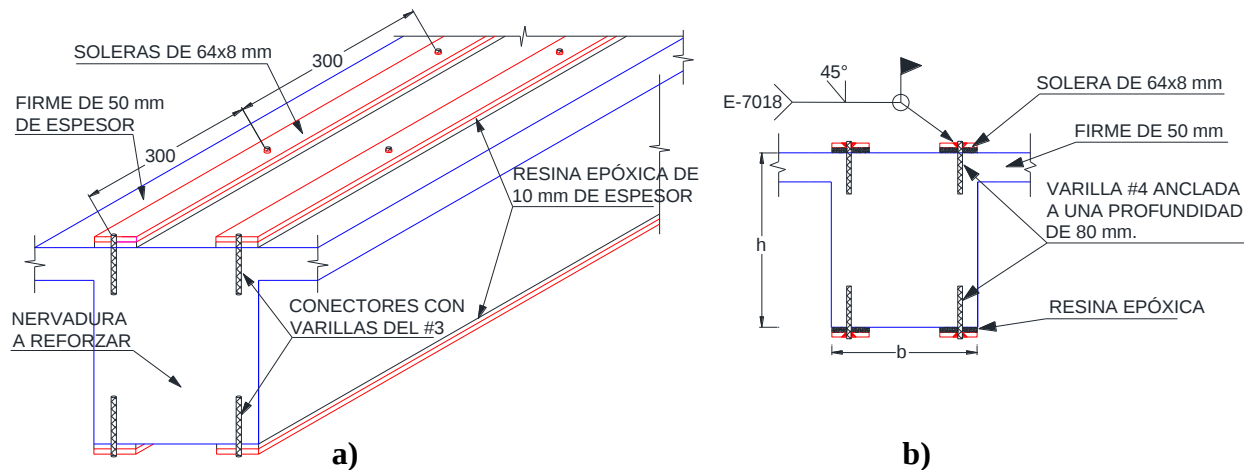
Detalles de refuerzo en las nervaduras y zonas macizas, a) corte transversal en nervaduras y b) vista lateral del refuerzo.
